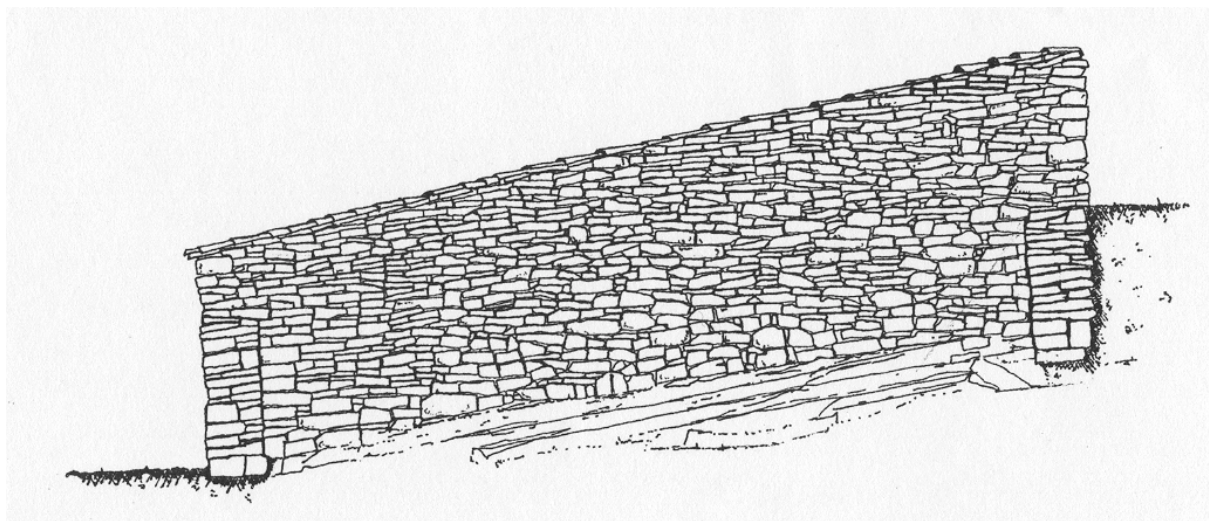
Parideras en Herrería (Guadalajara). Alzado lateral
